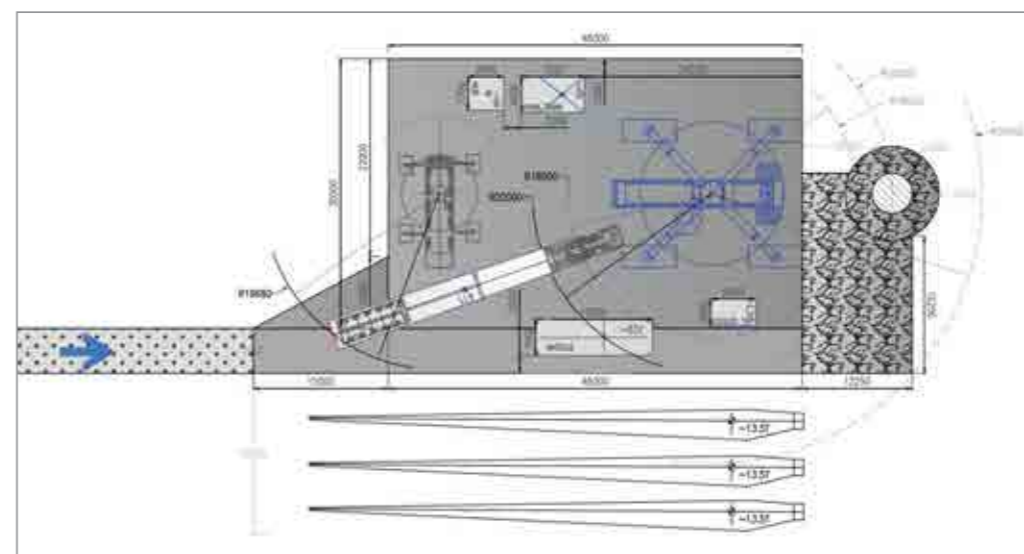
Configurations types des plateformes des éoliennes V112, V117 et V126, hauteur de moyeu inférieur à 119 m (source : Vestas)
